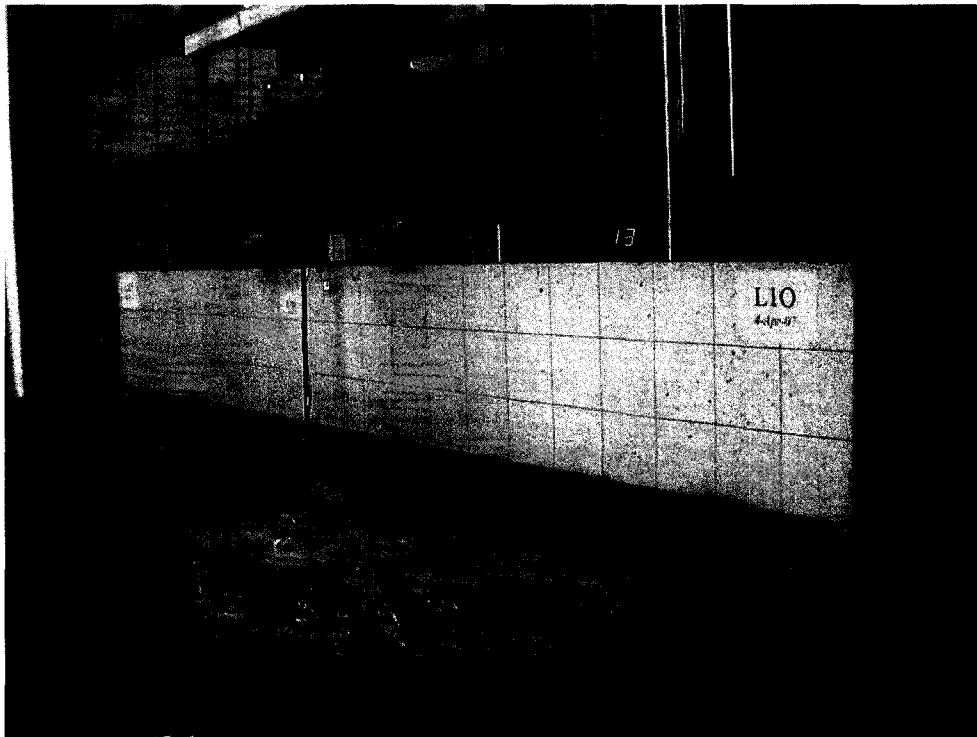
Montage expérimental – Essai sur la poutre L10
